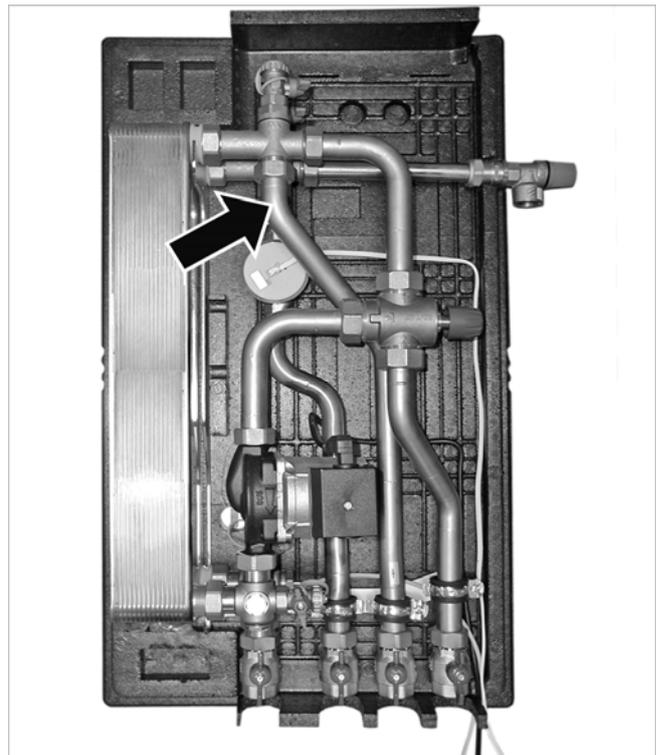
Position Rücklauf-Temperaturfühler (S14)
